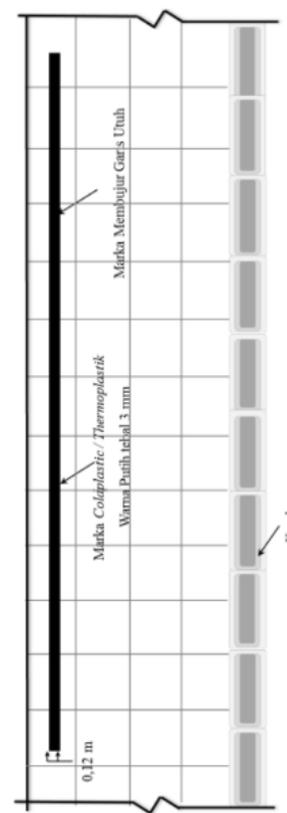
Marka membujur jalur sepeda tipe A di badan jalan.
